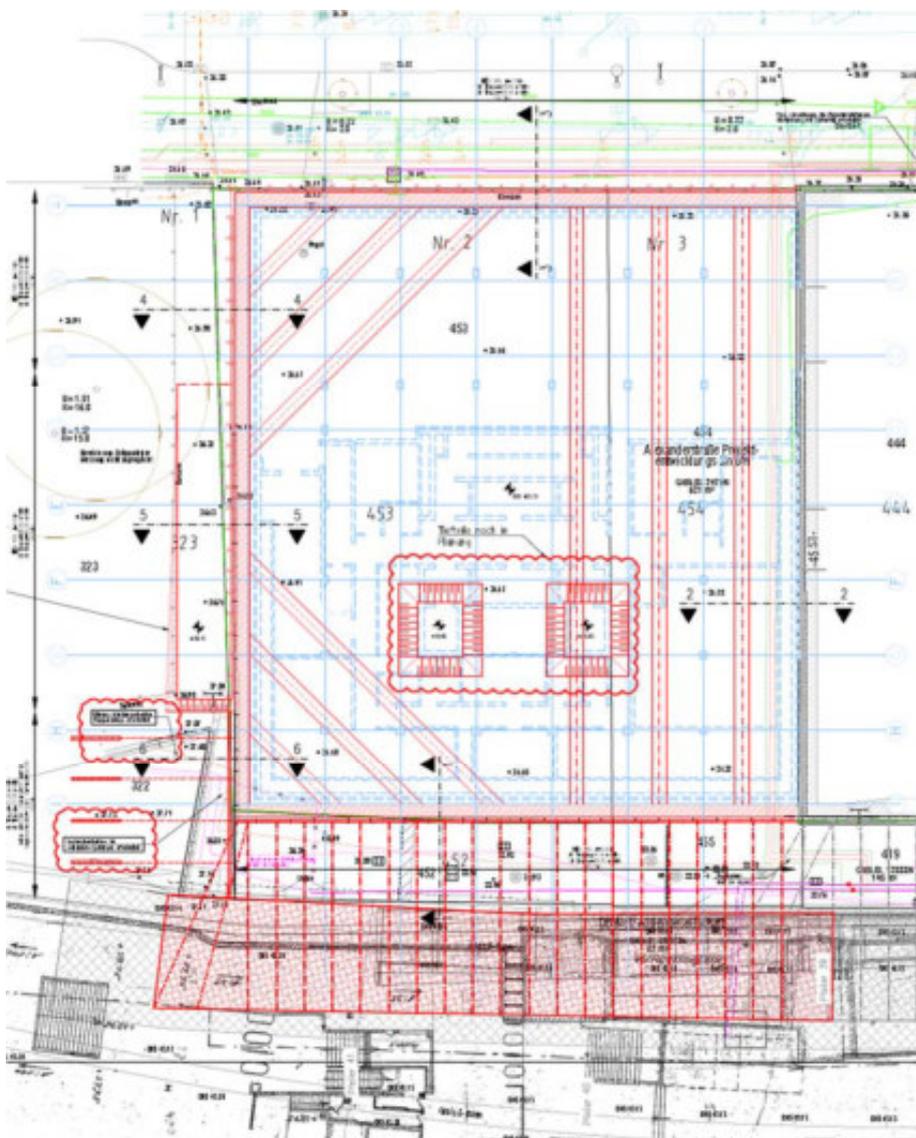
Baugrubengrundriss mit geplanter Anordnung der Injektionslanzen zur Hebungsinjektion (Entwurfsplanung Stand März 2021)
